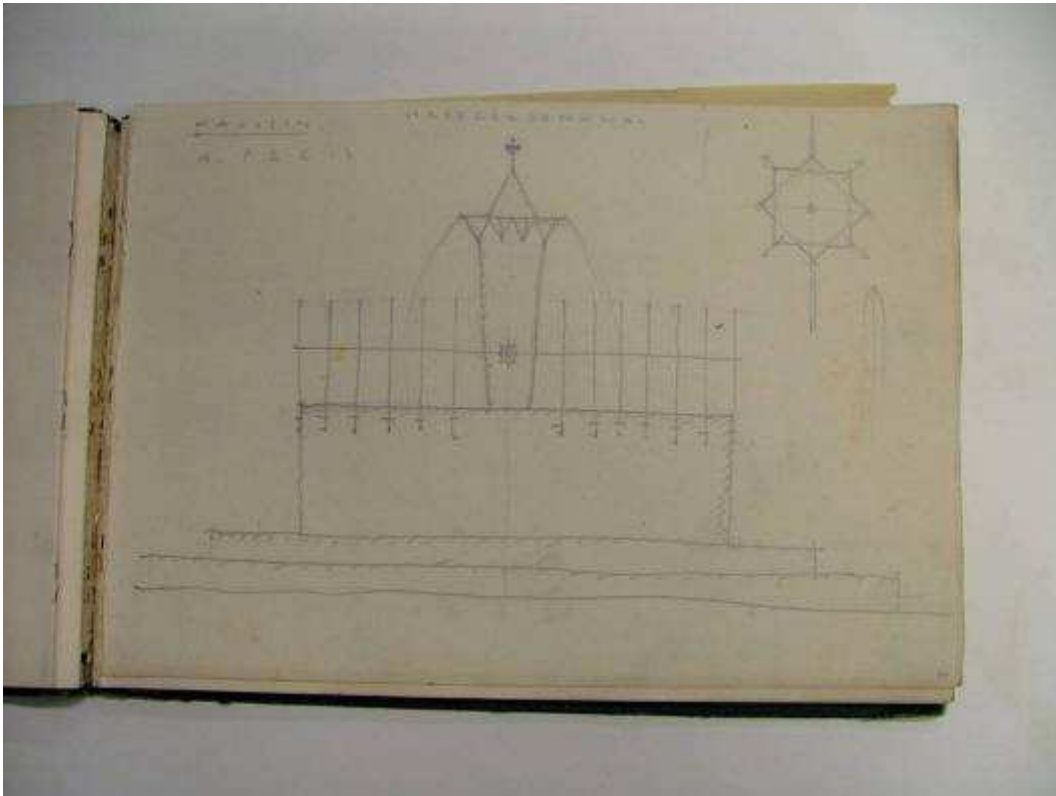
Otto Strohmayer, Ansicht, Kriegerdenkmal, Hallein, undatiert (HSS, INR 1674-1675).
